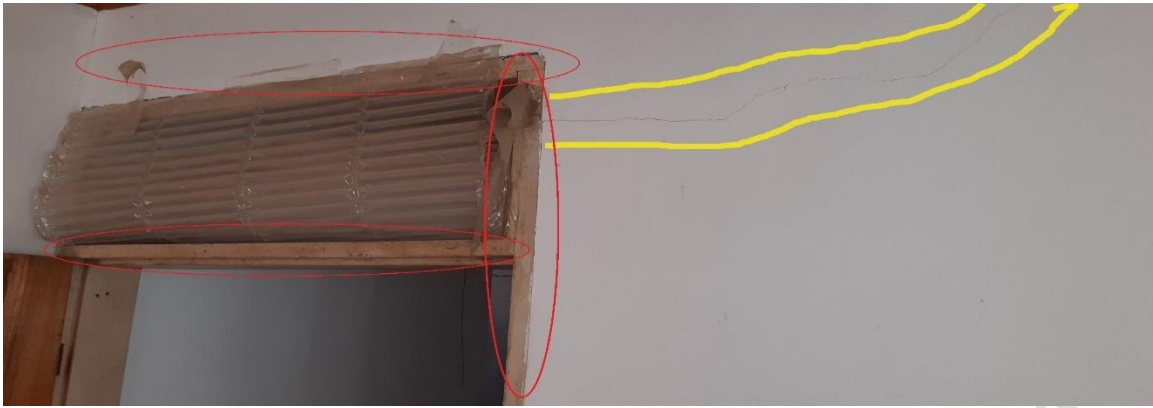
Fisuras y grietas en sentido horizontal, con desprendimientos de enlucidos y afectación de los marcos.
